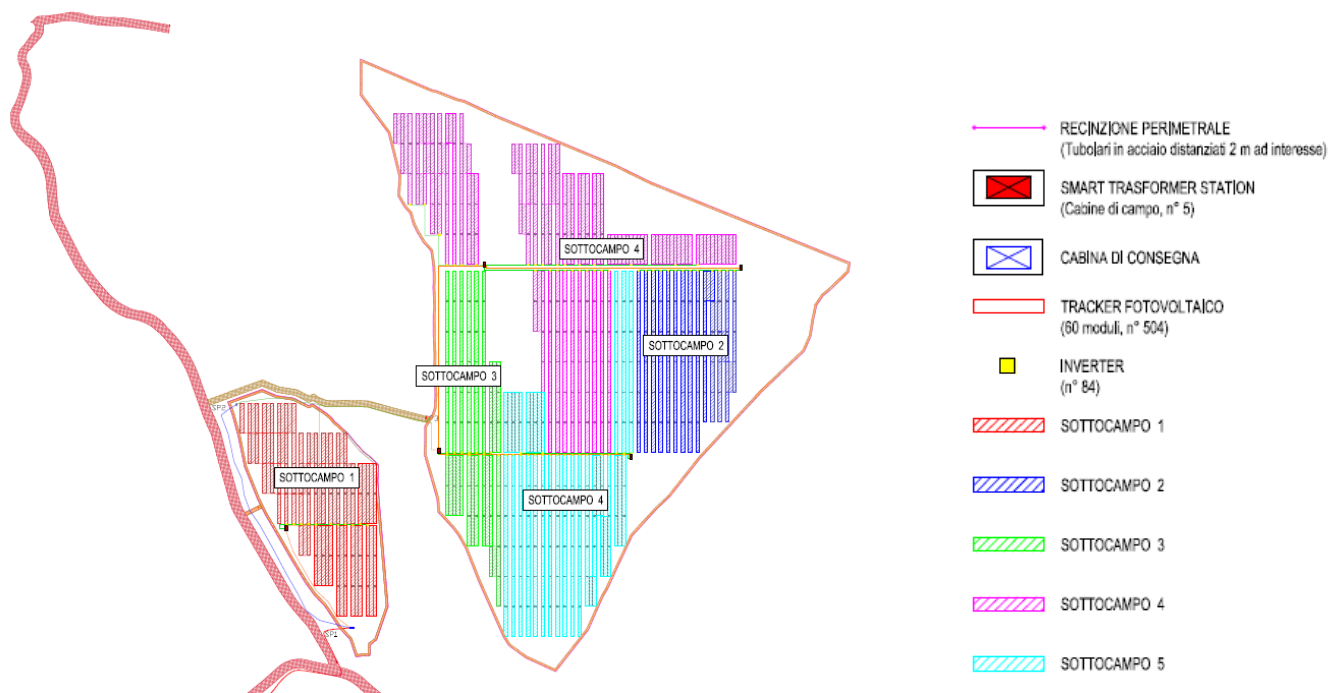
Stralcio planimetrico con indicazione dei sottocampi
